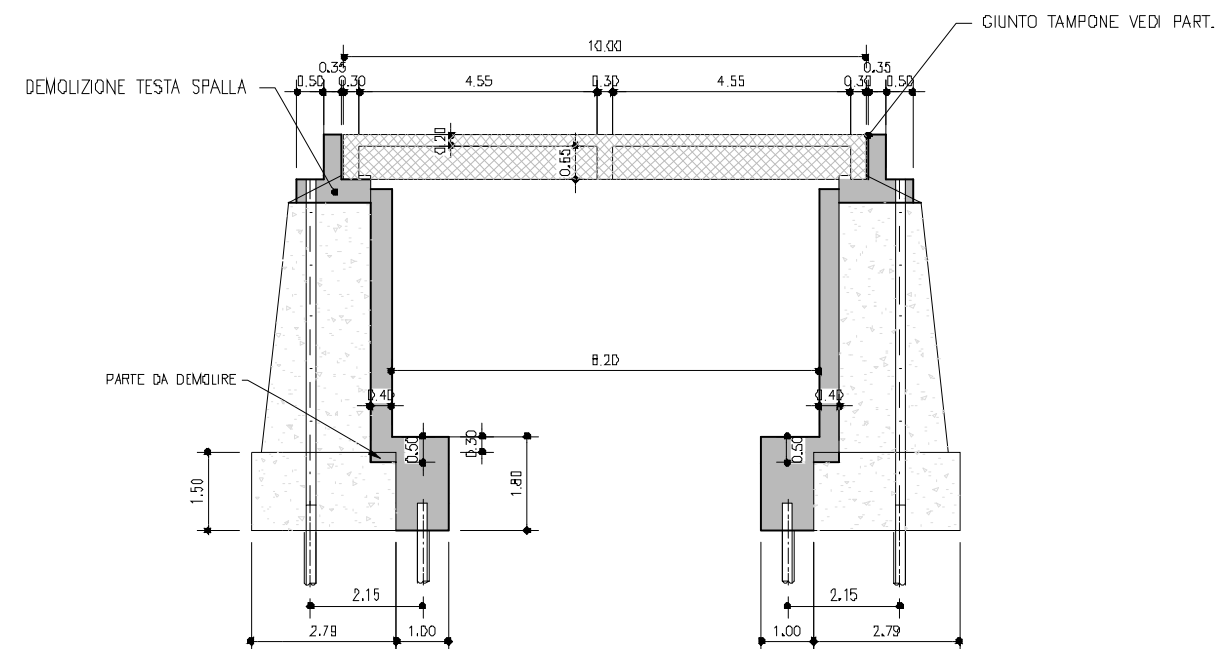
Sottovia di via XI Settembre. Sezione longitudinale
